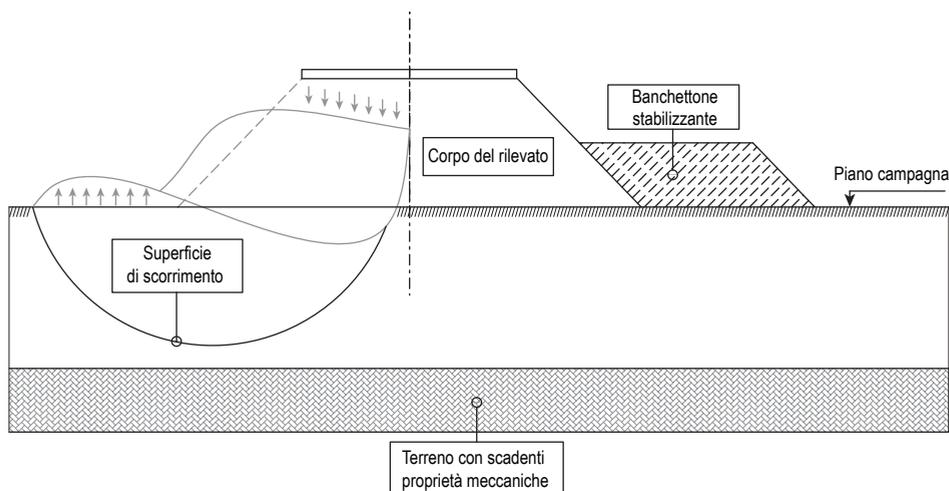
Rottura di un rilevato per instabilità del piano di posa
